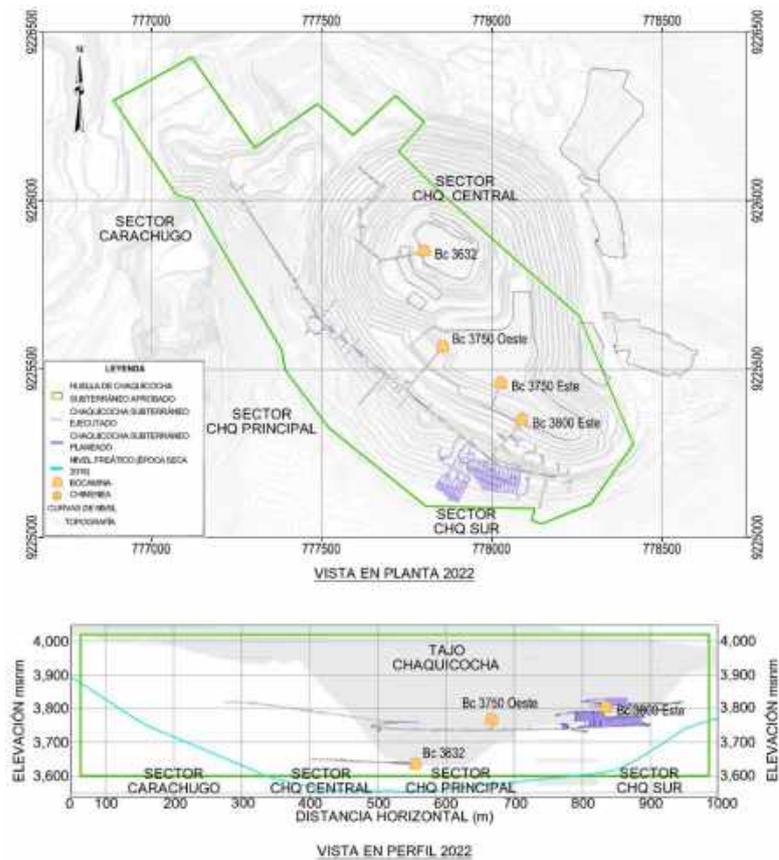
Plan de producción de Chaquicocha Subterráneo - año 2023 - Vista en planta y perfil
